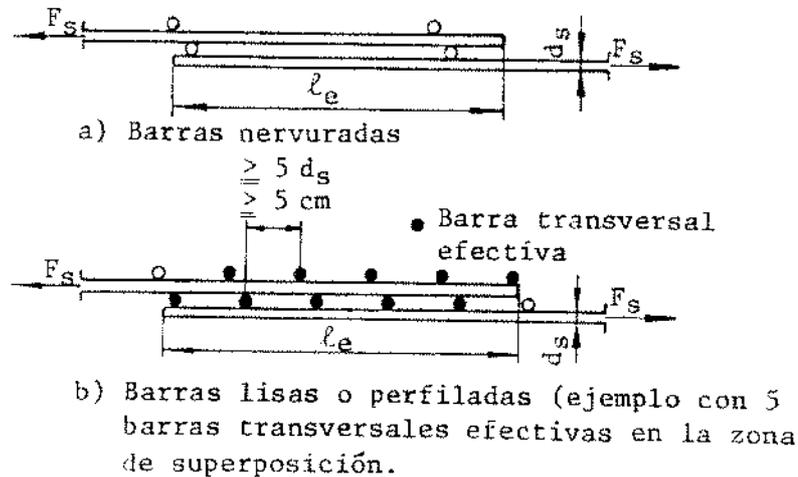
Ejemplos de empalmes por superposición de mallas soldadas en dos planos (empalme traccionado).
